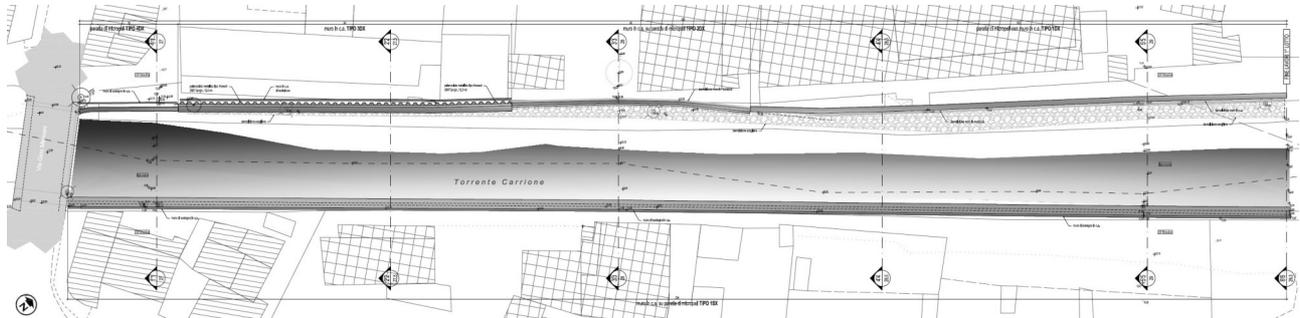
vista planimetrica del tratto interessato dall'intervento in oggetto (da sez. 29.3 a sez. 27).
